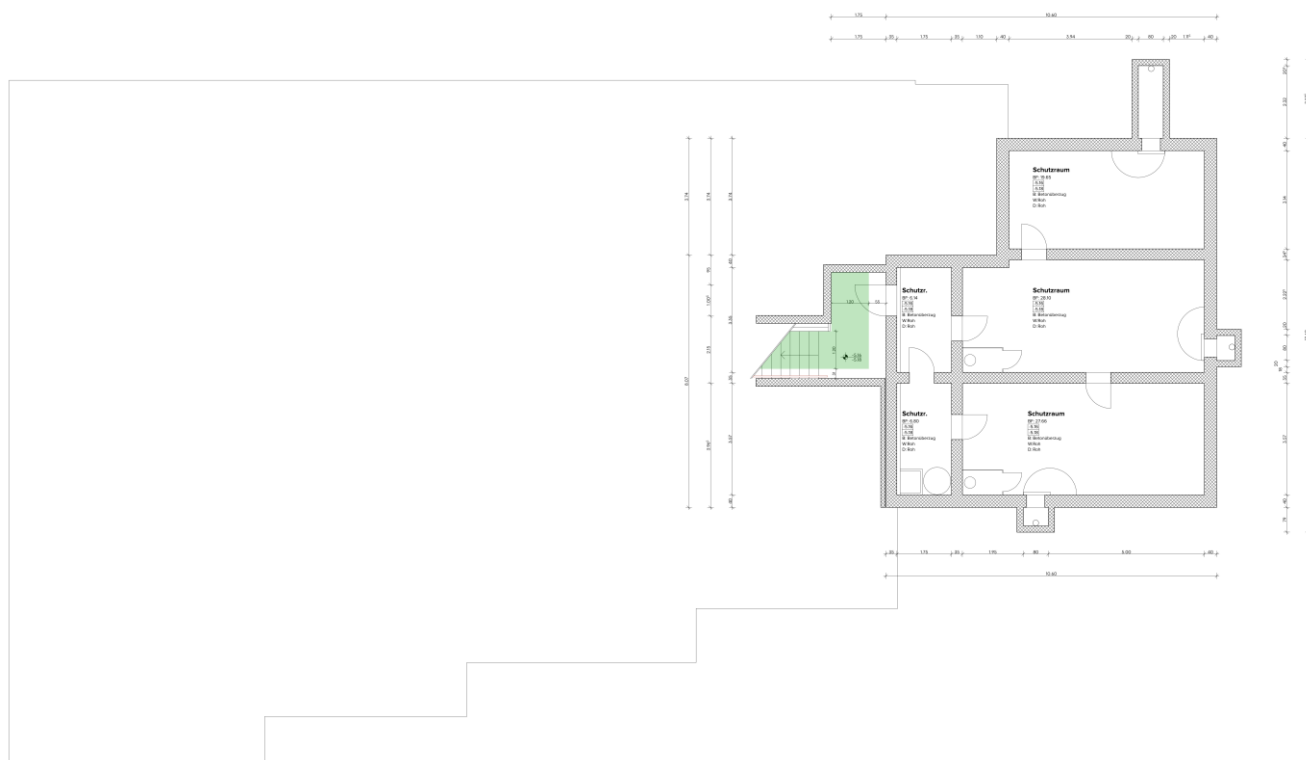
Grundriss 2. Untergeschoss, Gebäude 3
